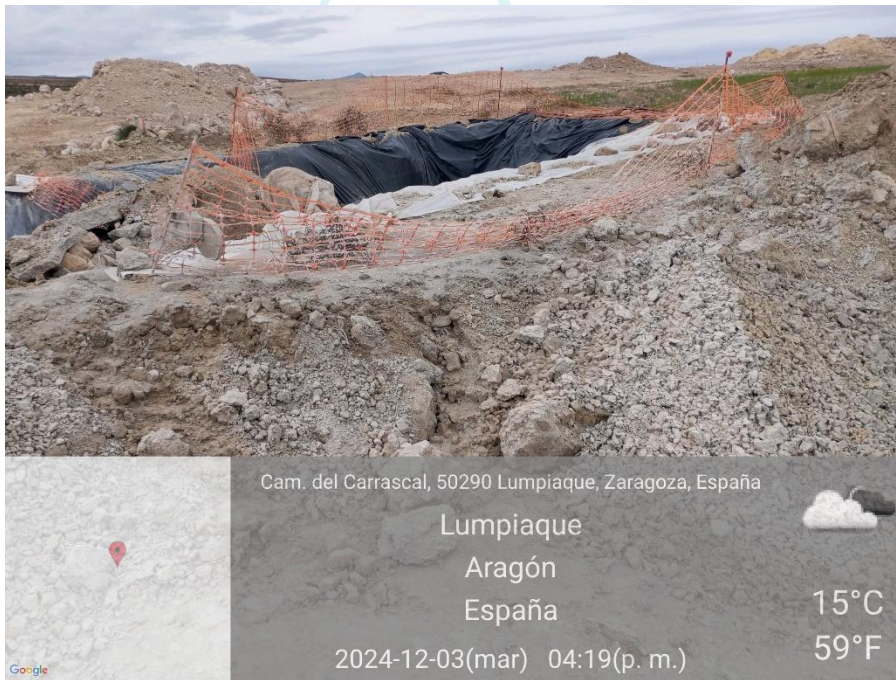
Vertido de hormigón fuera de la balsa de hormigón.
